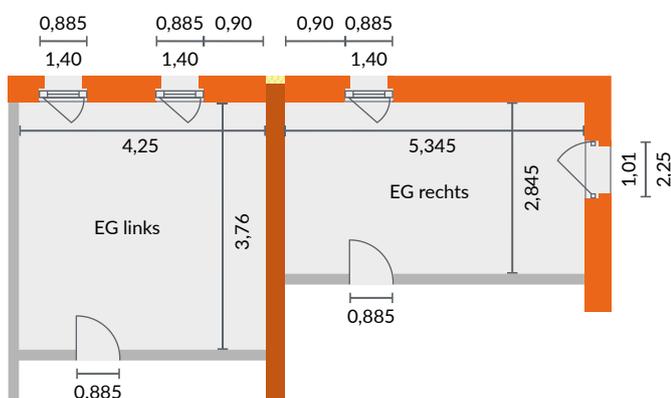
Grundriss zweier nebeneinanderliegender Wohnräume (Maßangaben in m)
